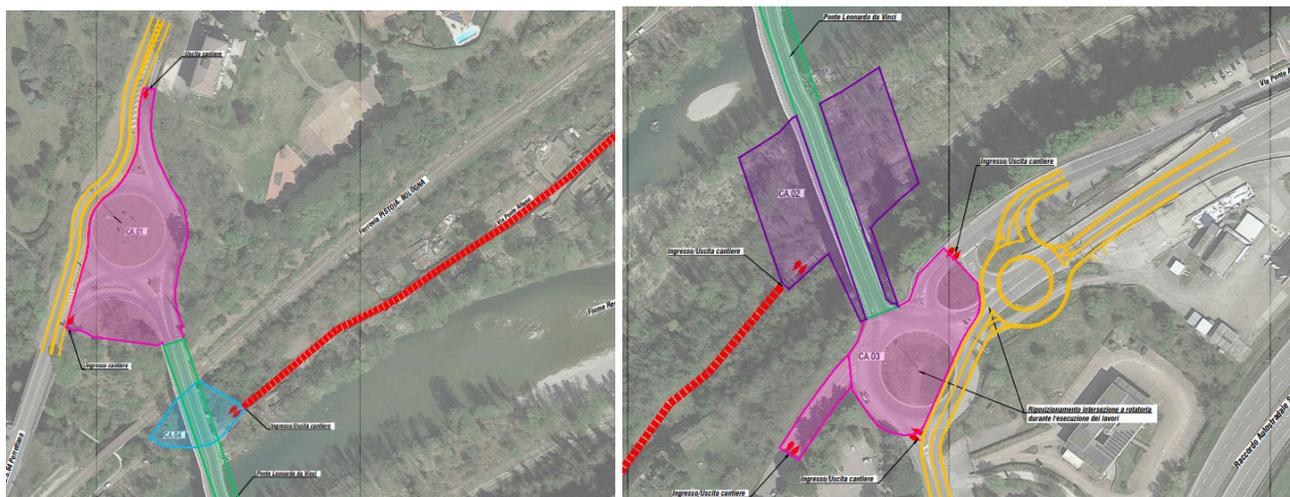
Dettaglio della planimetria di cantiere. Sinistra: area a nord del ponte. Destra: area a sud del ponte (Fonte: Allegati alla Lista di controllo)
